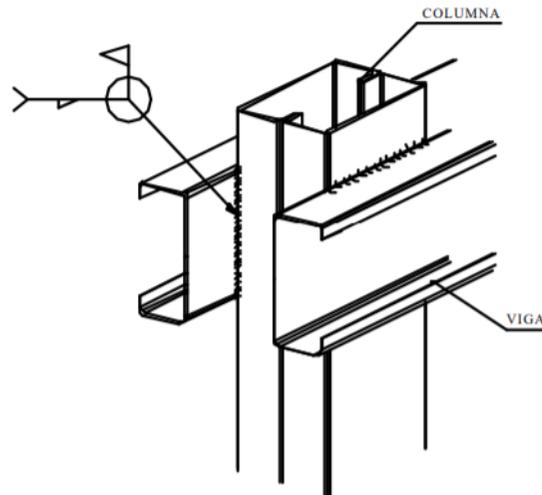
Detalle anclaje de columna con vigas, mediante soldadura
